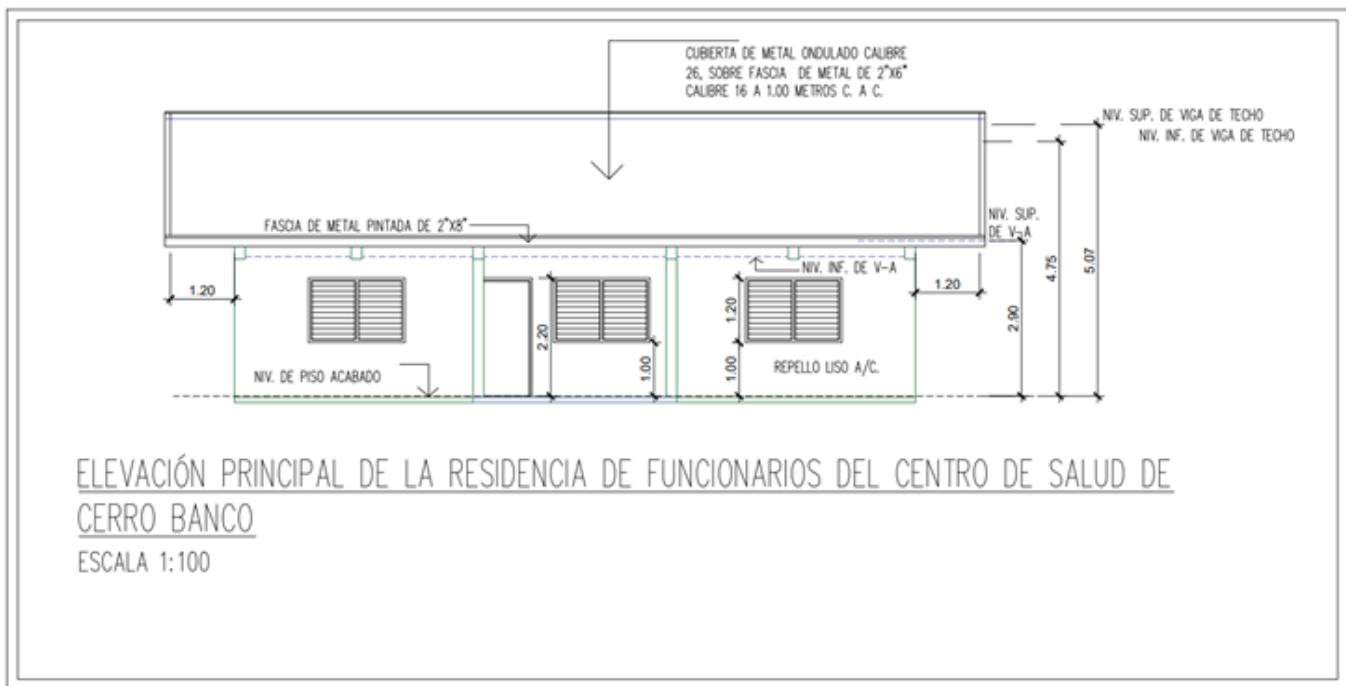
y #5 – Vista de elevaciones de Centro de Salud de Cerro Banco.
